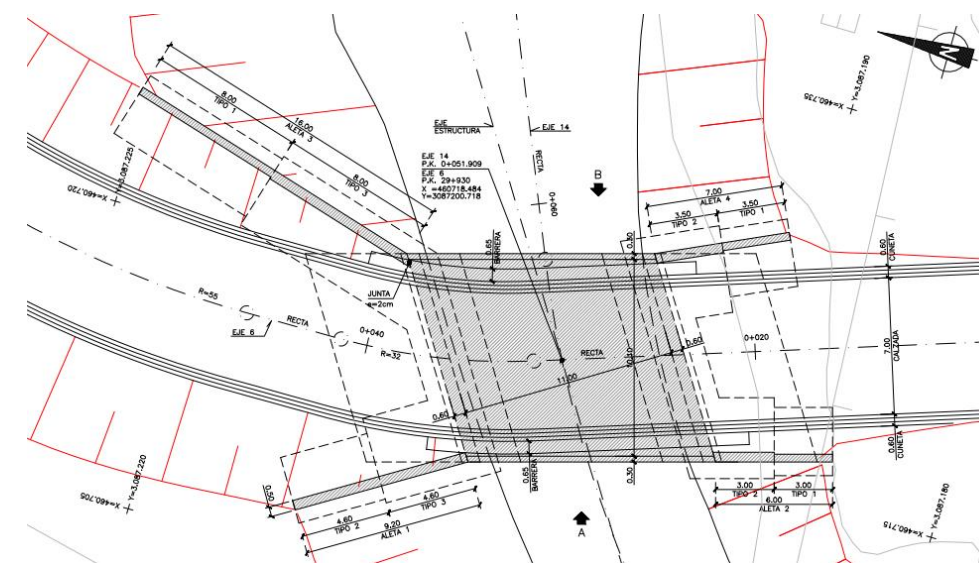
Planta de paso inferior (fuente: PC estación El Carrizal)
